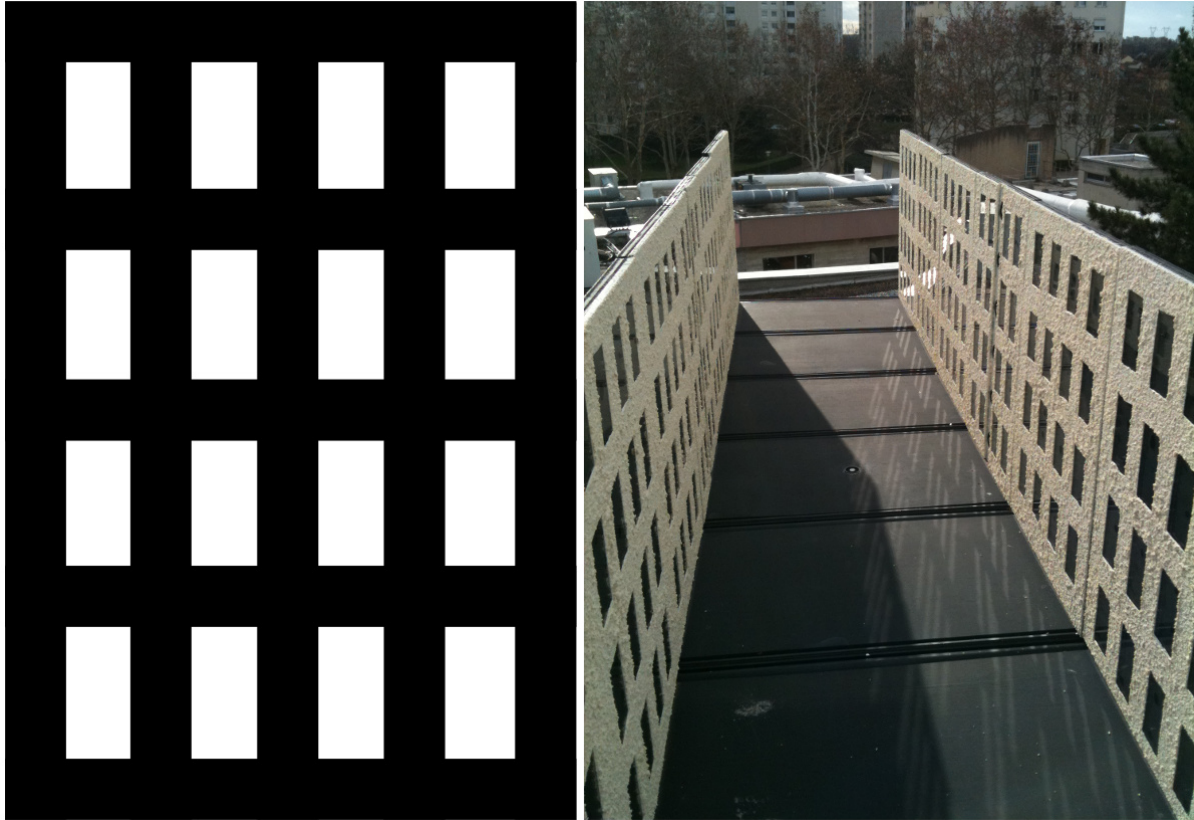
Façades utilisées sur la maquette (à gauche)
